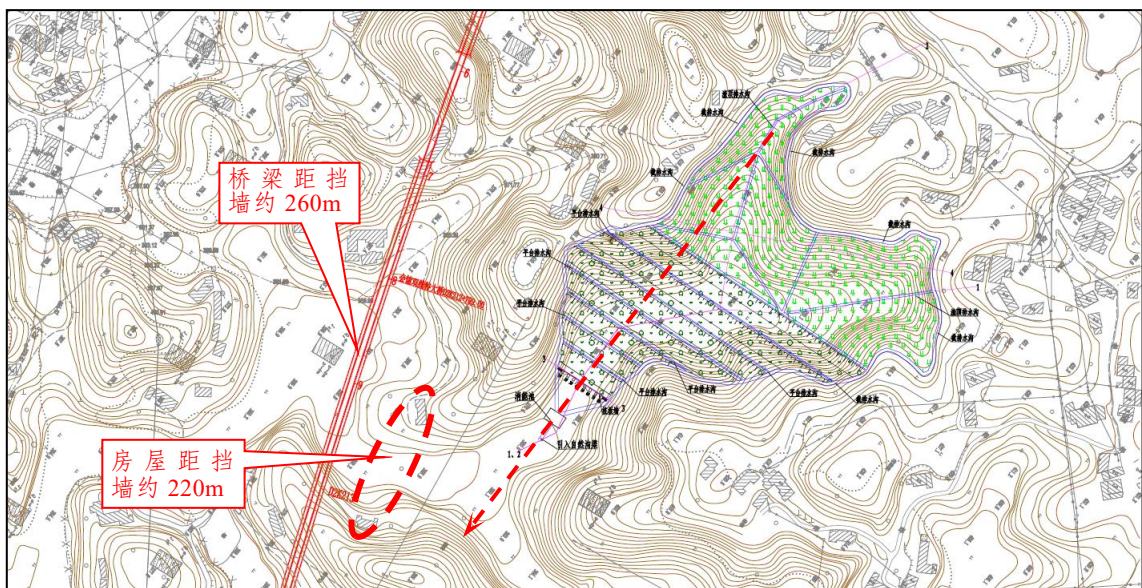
3#-赵场梨子村 1 号弃渣场平面图
